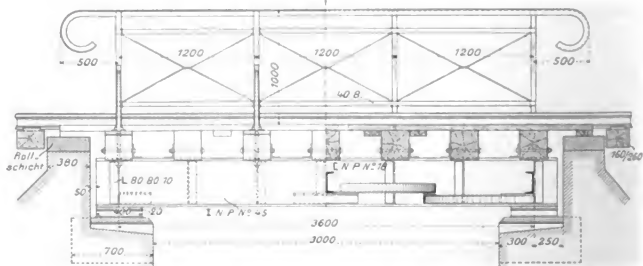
u. 305. Grundriß und Horizontalschnitt.
